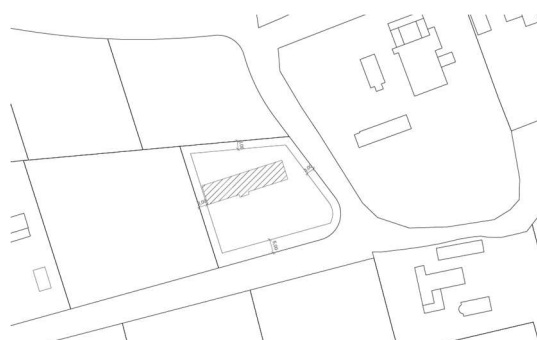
Emplazamiento vivienda. 2024. Fuente: Elaboración propia
